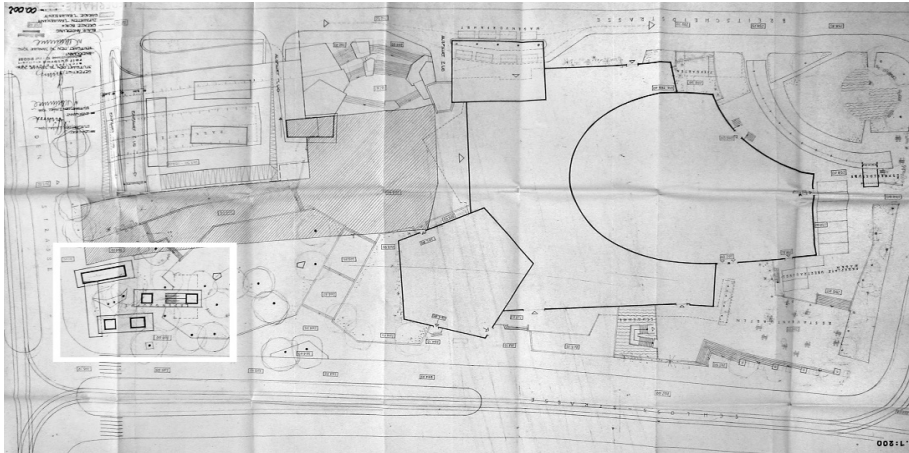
Lageplan, kleine Ladengruppe (Bildrand links unten), Büro Gutbrod. In dem Vorgelände zwischen Schloss-, Seiden- und Breitscheidstraße, dem oberen Haupteingang, waren zusätzliche kleine Ladenzonen geplant gewesen.
